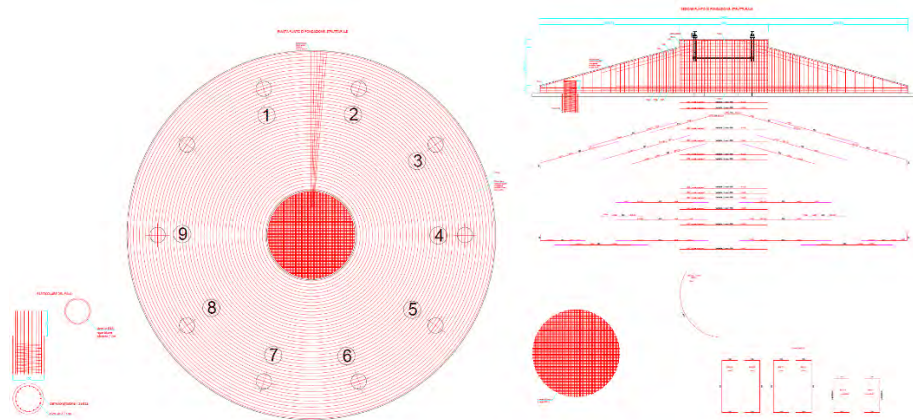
Pianta-sezioni e armature del plinto di fondazione (ElaboratoGrafico armatura Plinto)
